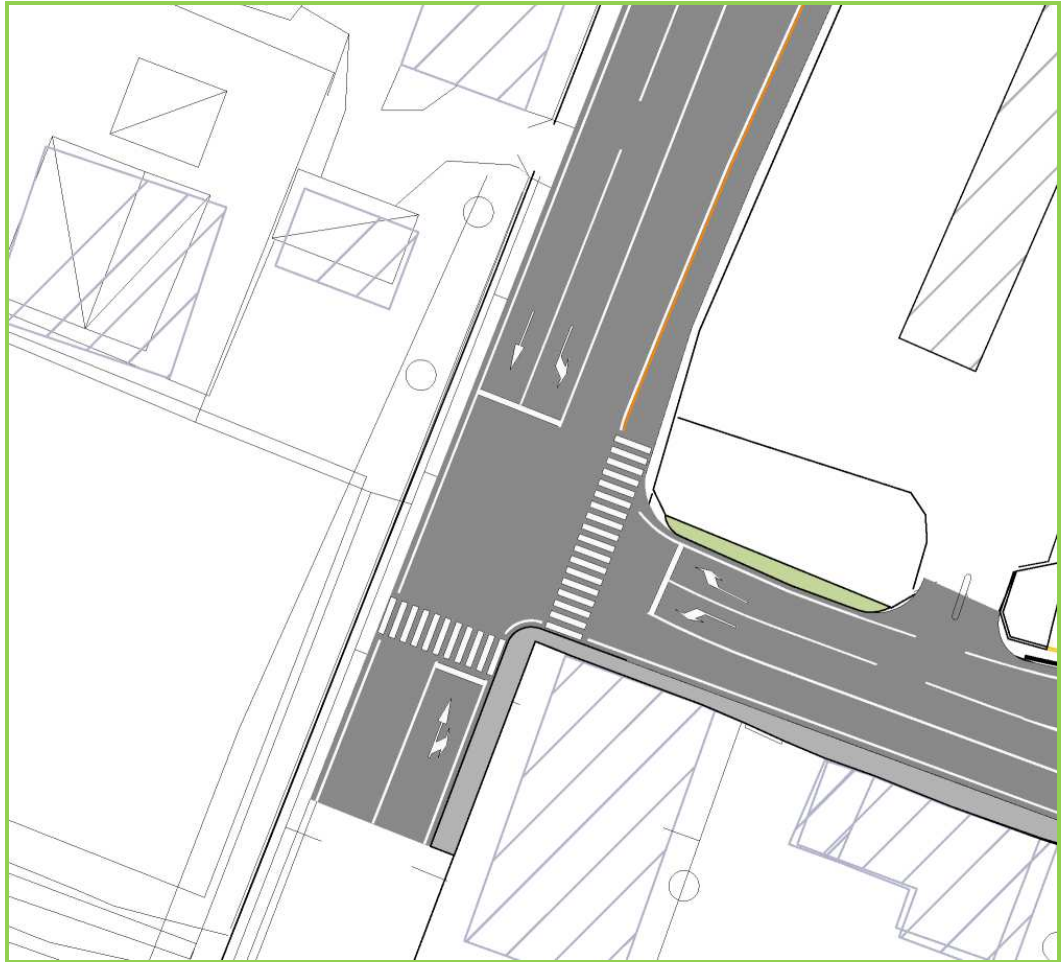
Planimetria Intersezione via Vigasio – via Mezzacampagna
